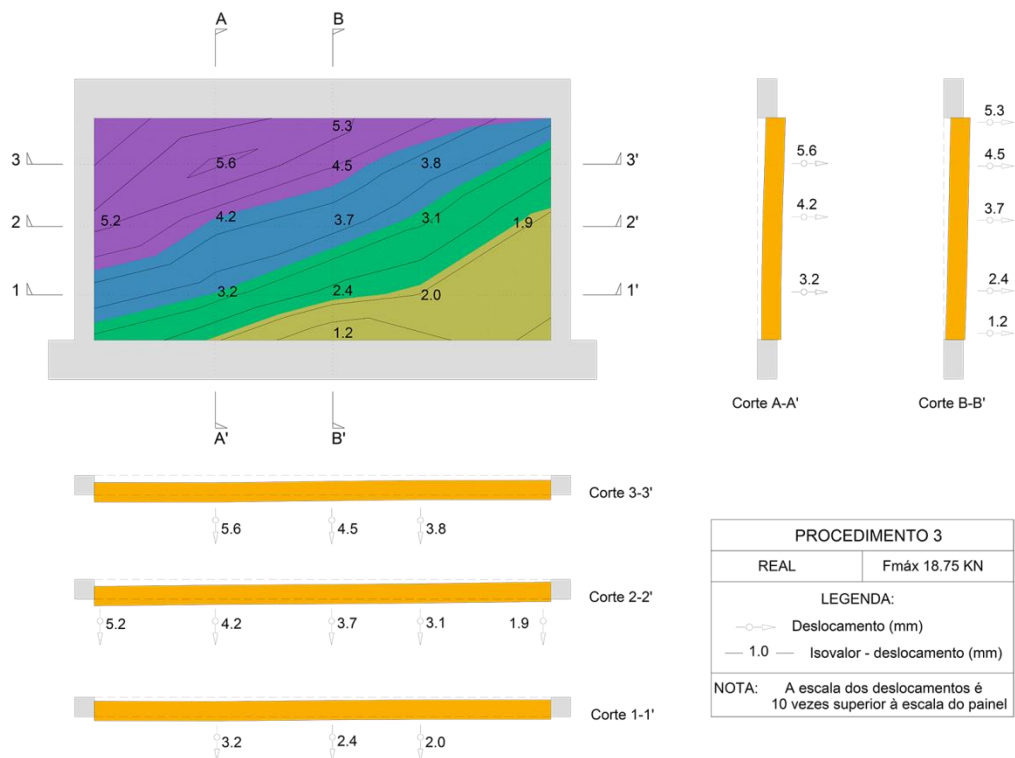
Isovalores da parede ensaiada - Procedimento 3. Ensaio fora do plano, Wall_RAR_01.
